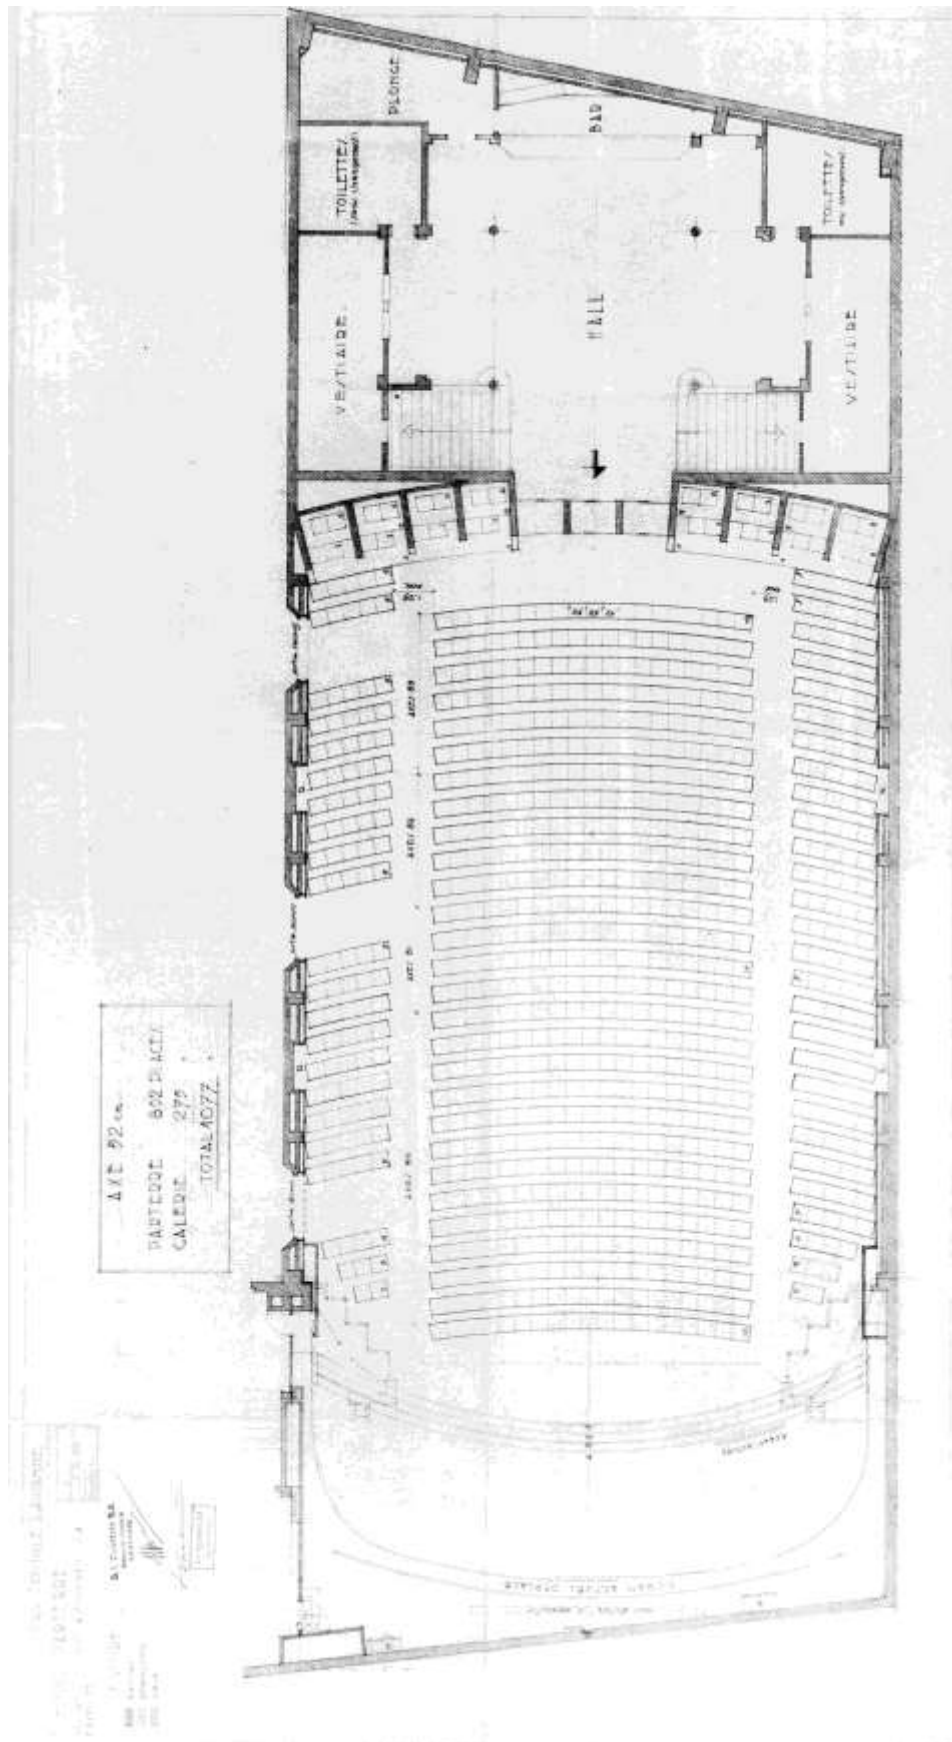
Plan du parterre, Gérald Pauchard architecte, 3.4.1959 (AVL).
